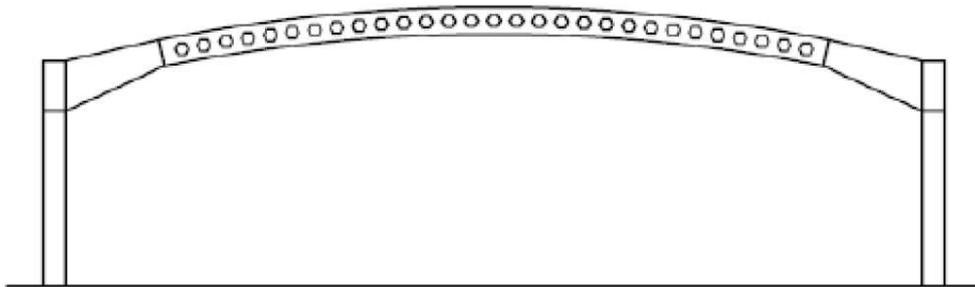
Pórtico con Dintel de Viga Aligerada
